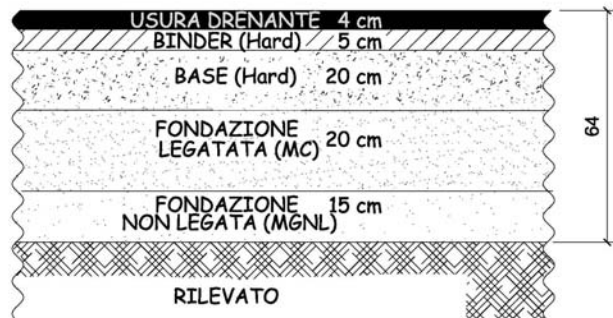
Sovrastruttura nuove pavimentazioni (TIPO 1)
